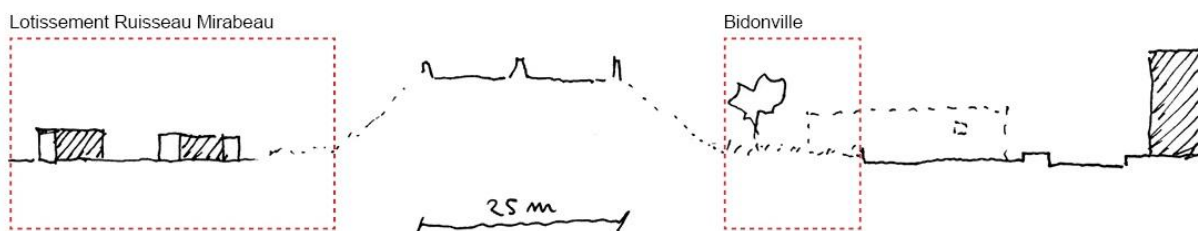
Coupe sur le lotissement, l'autoroute et le bidonville, fait par M. Serre
